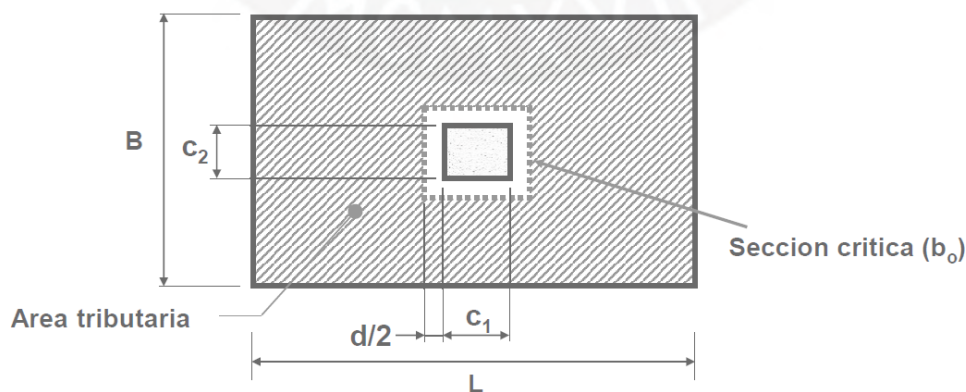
Sección crítica para la verificación por punzonamiento en zapatas
